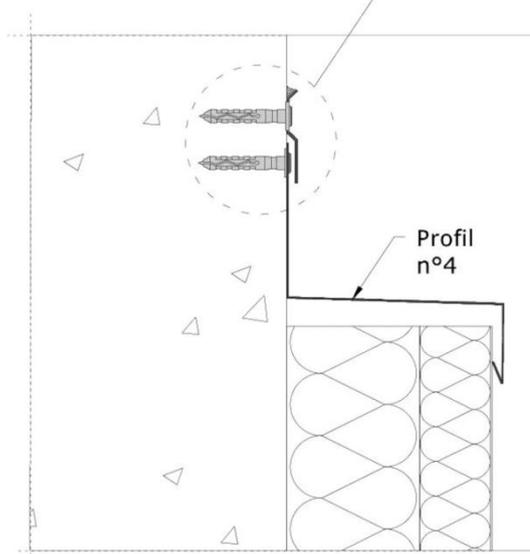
1 - Bas de façade – Pose en bardage rapporté (coupe verticale)
